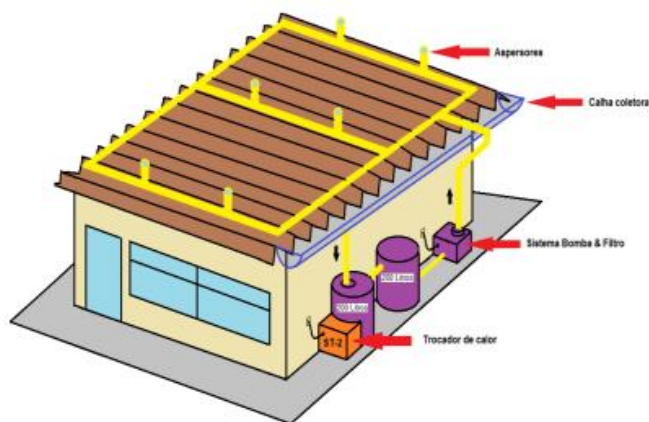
ILUSTRAÇÃO DA PLANTA HIDRÁULICA DO REFEITÓRIO. FONTE: PRÓPRIA (2016).
